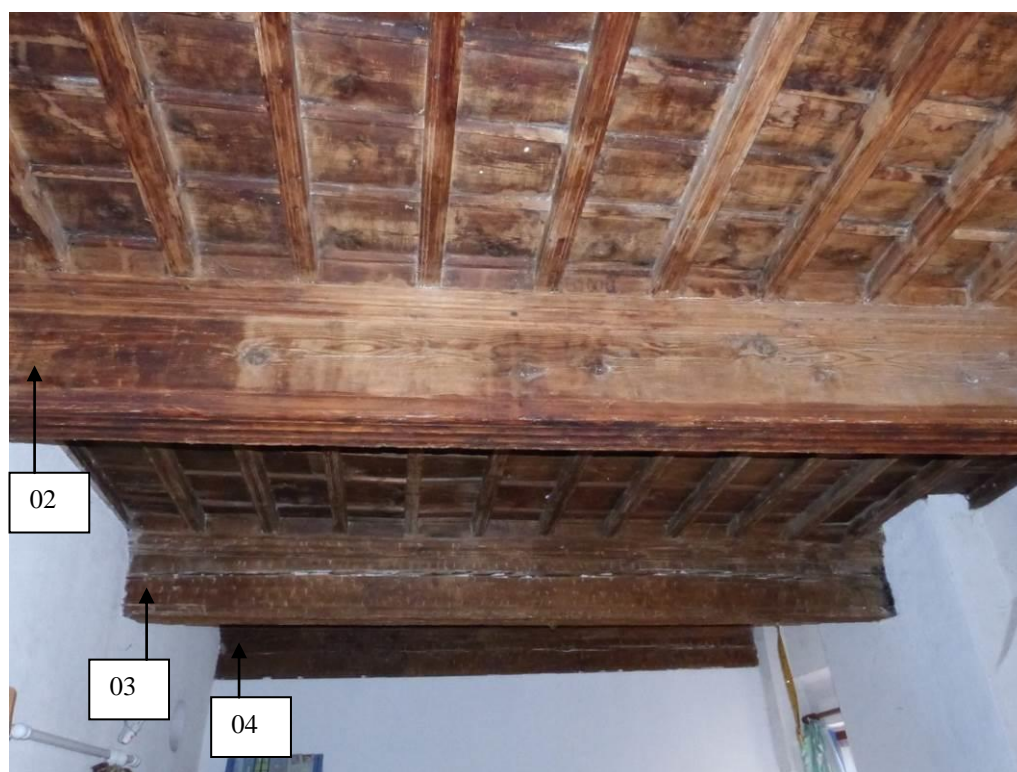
Vue du plafond depuis le sud-ouest de la pièce. La face latérale sud-ouest de la deuxième poutre, celle au premier plan, n'est pas recouverte d'entailles (Blégiers, Prads-Haute-Bléone).
